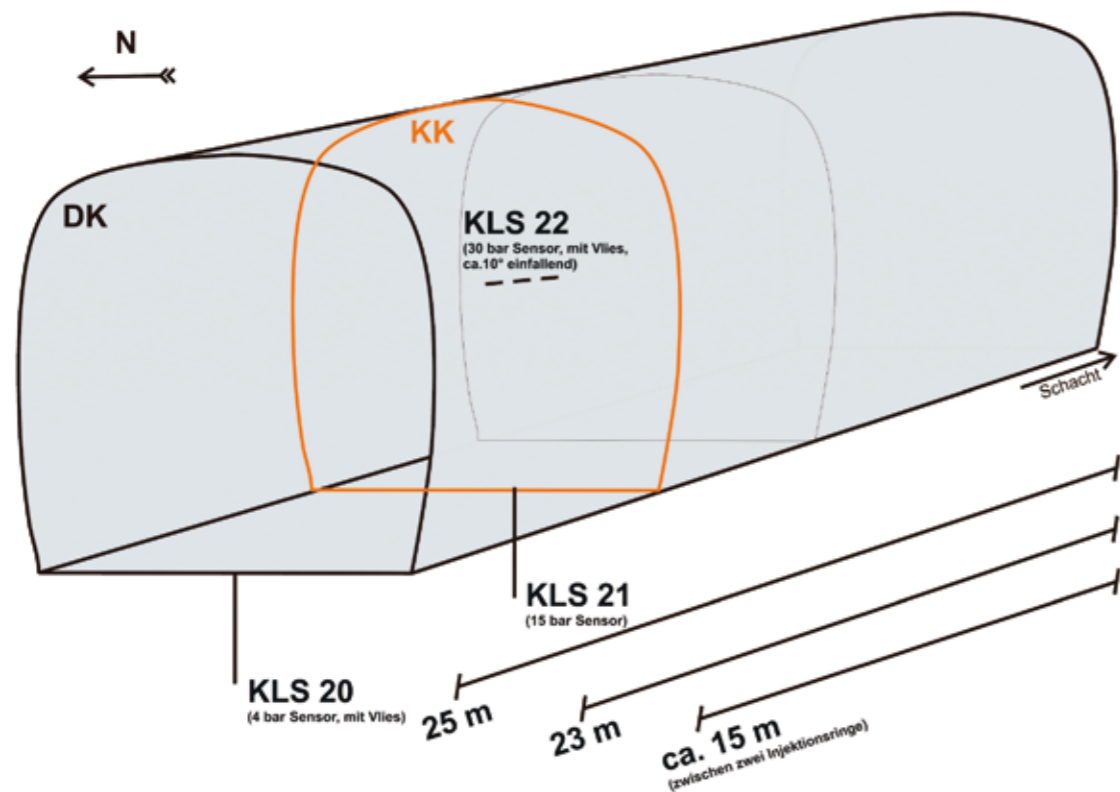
Lage der Funksensoren im Verschlussbauwerk aus Beton / position of radio sensors within the concrete gallery sealing
